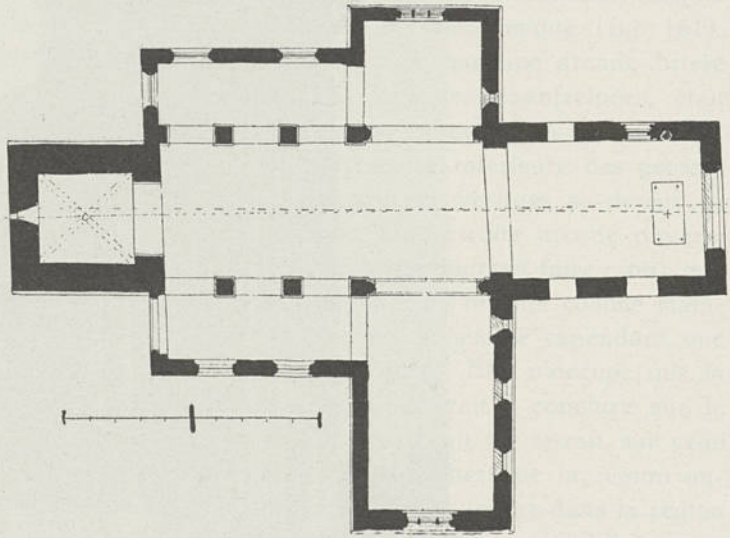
Grimde, Eglise Saint-Pierre, plan terrier, avant la restauration
